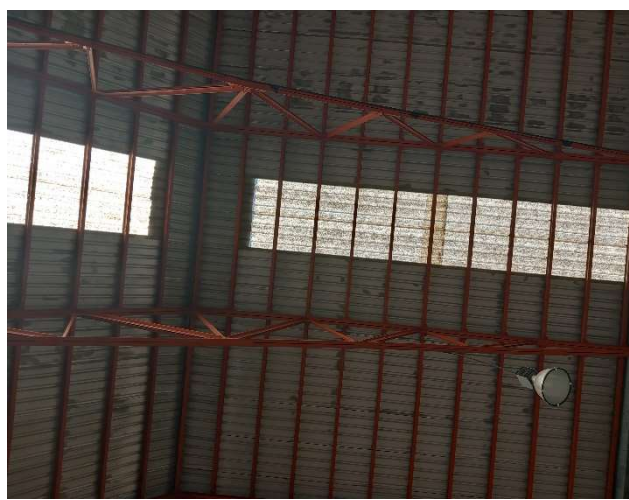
e 4 – Vista dei lucernai dall'interno dell'edificio C13A
